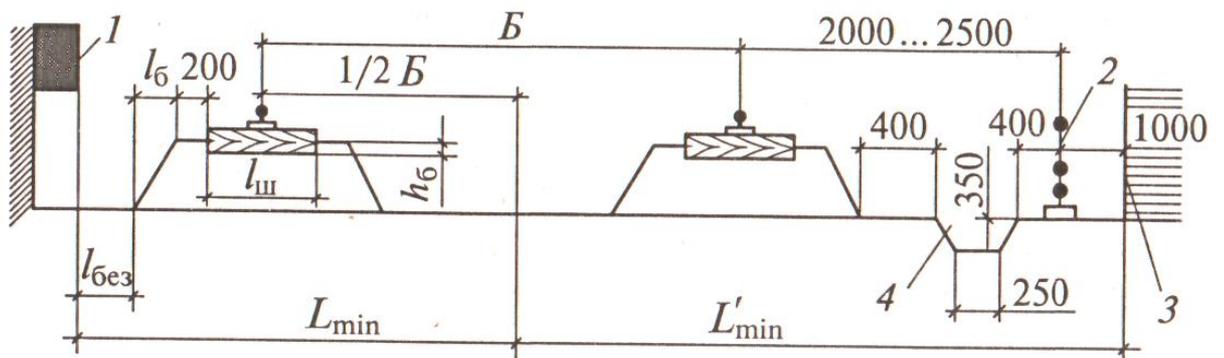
Примеры установки башенного крана на стройплощадке.
